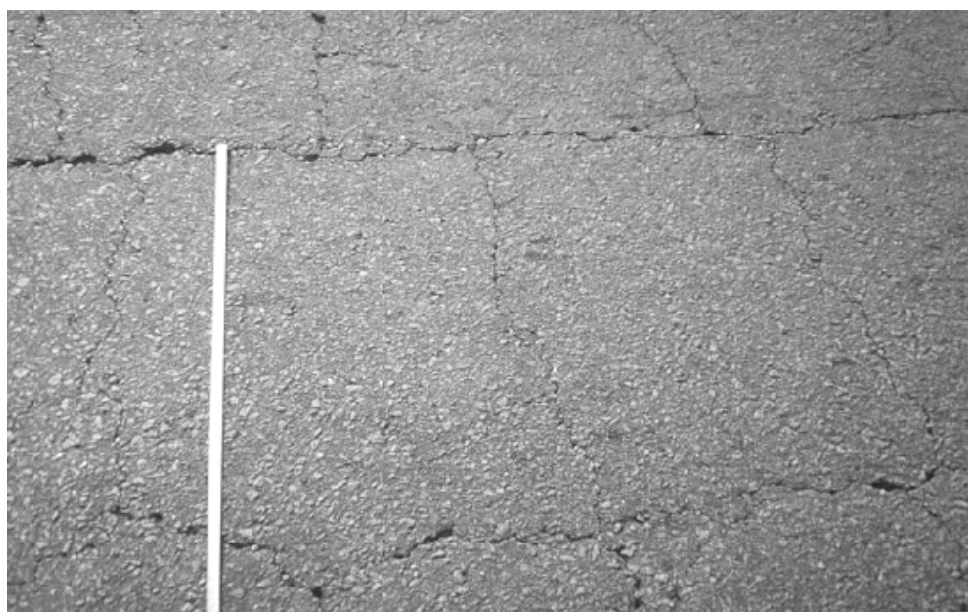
Fendilhamento tipo “pele de crocodilo” num pavimento
